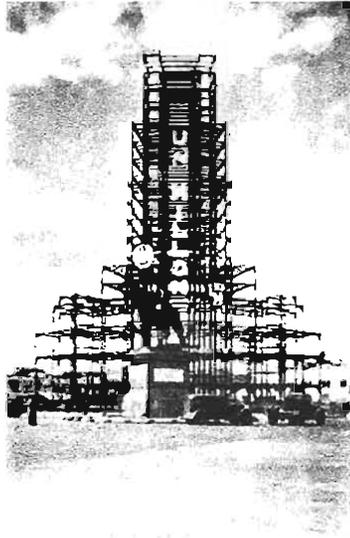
Construcción del edificio de la Lotería Nacional, ca. 1938
